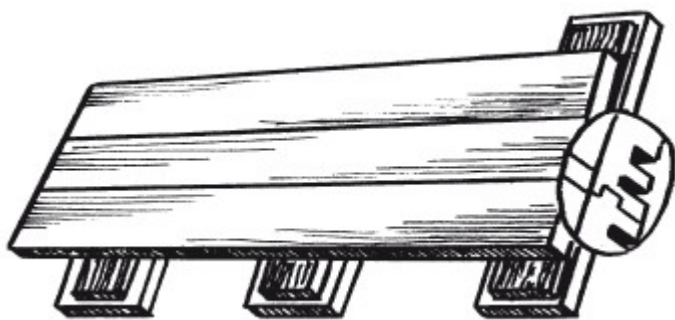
Устройство паркетных полов по железобетонному перекрытию по лагам на звукоизоляционных прокладках
